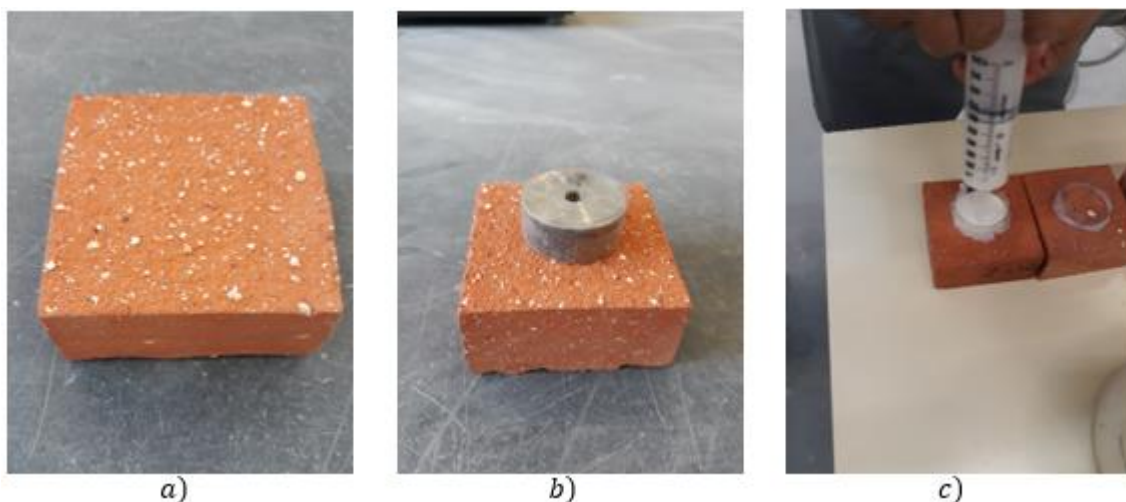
a) Aspetto visual do tijolo, b) Aplicação do acetato, c) Aplicação da calda com uma seringa.
